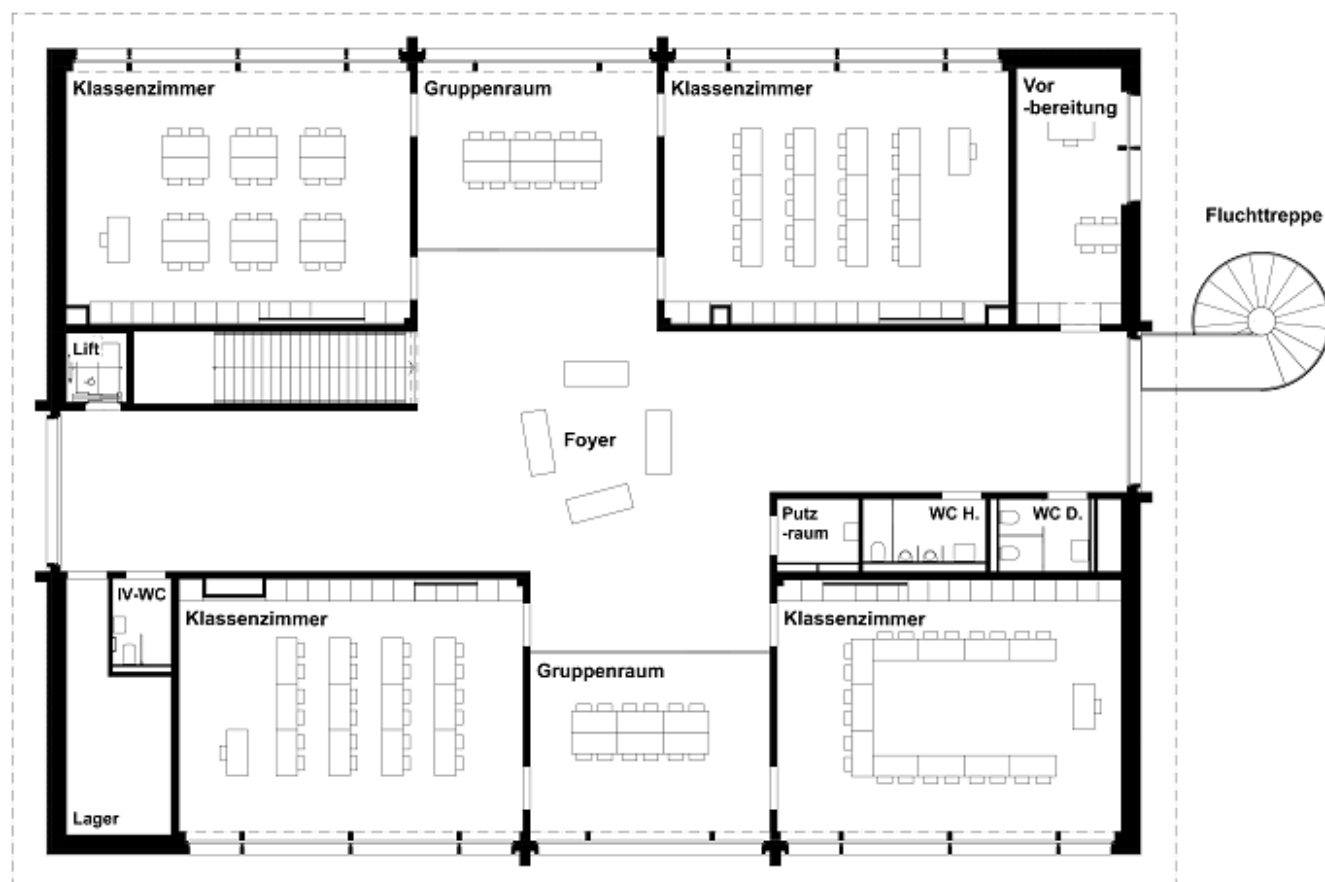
; Grundriss Aufstockung 2. Obergeschoss.
